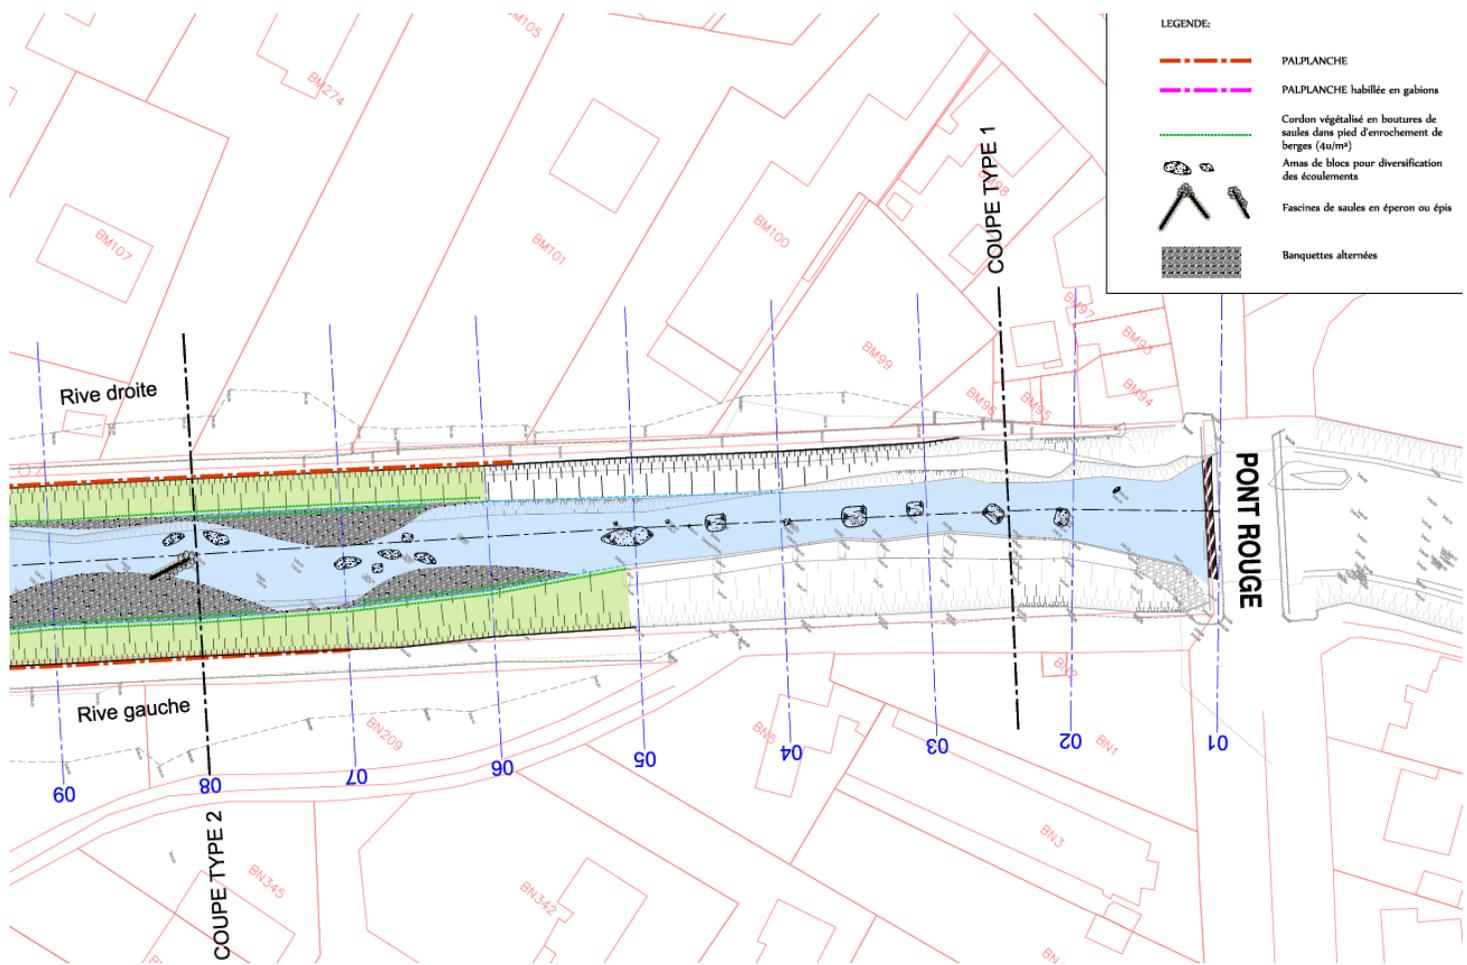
Vue en plan du confortement des digues du Sierroz - Planche de détail 2.3
